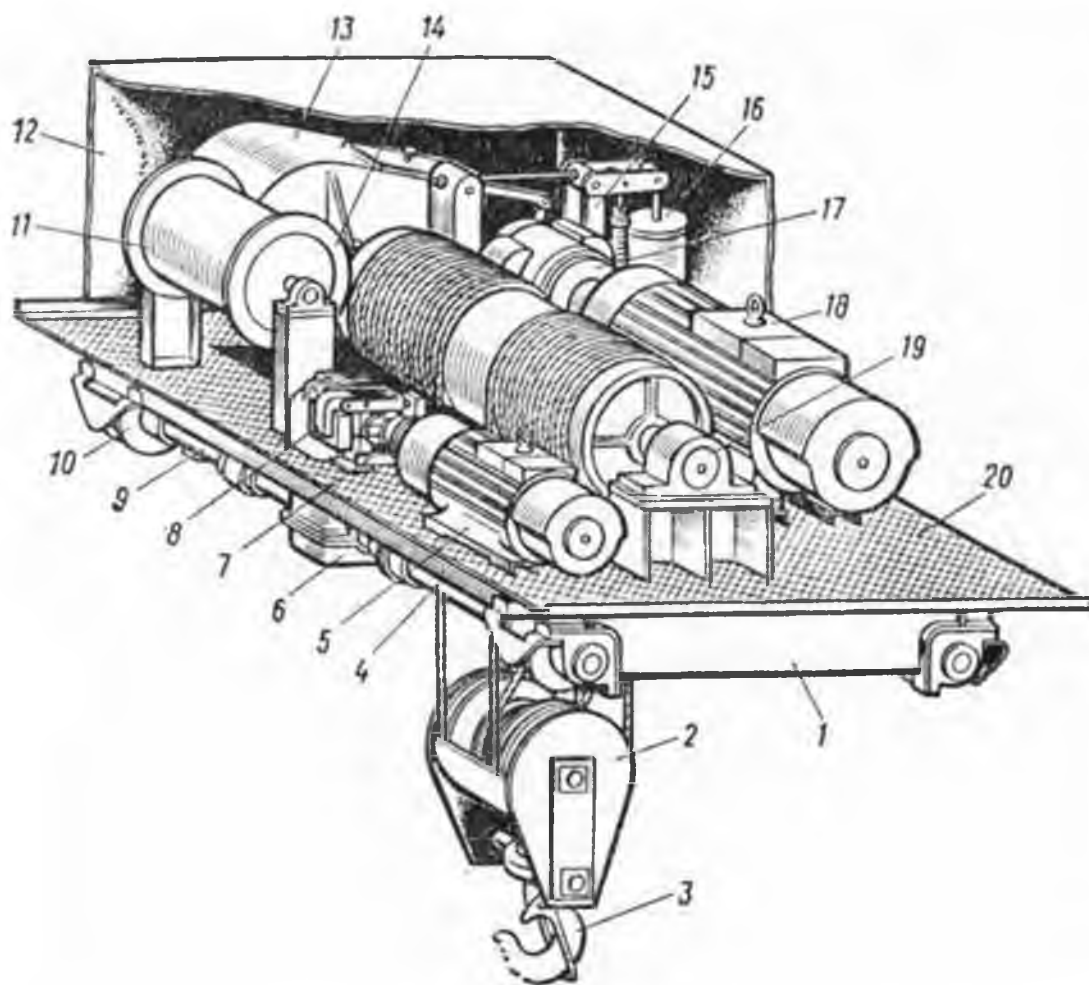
Вантажний візок крана КПБ-10М: 1 - рама; 2 - крюкова обойма; 3 - гак; 4 - ланцюгова муфта; 5 - електродвигун пересування; 6 - редуктор; 7,8 - гальмо; 9 - вісь ковзаник; 10 - каток; 11 - кабельний барабан; 12 - кожух; 13 - редуктор; 14 - вантажний барабан; 15 - гальмівний пристрій; 16 - гідроштовхачі; 17 - ланцюгова муфта; 18 - електродвигун підйому вантажу; 19 - підшипник вантажного барабана; 20 - поміст
